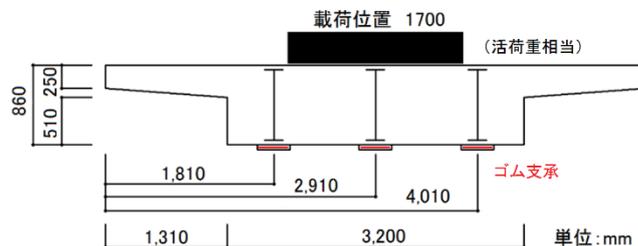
H 鋼埋め込み桁の断面図 (単位 mm)
